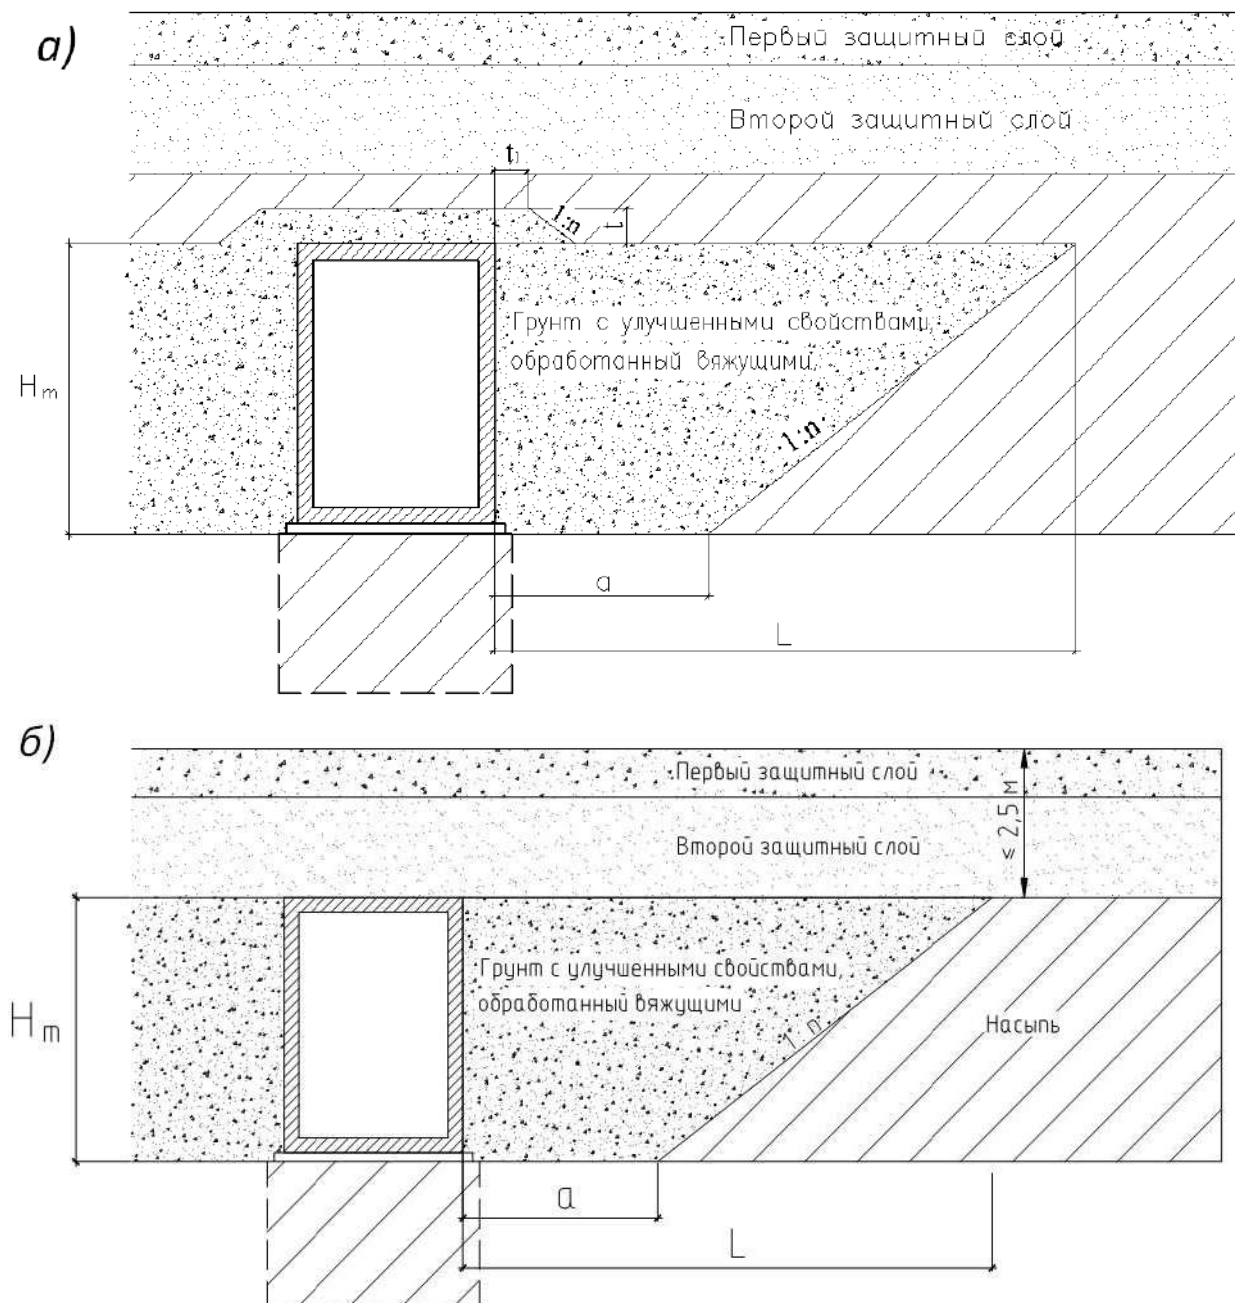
Конструкция сопряжения насыпи с водопропускными трубами:
